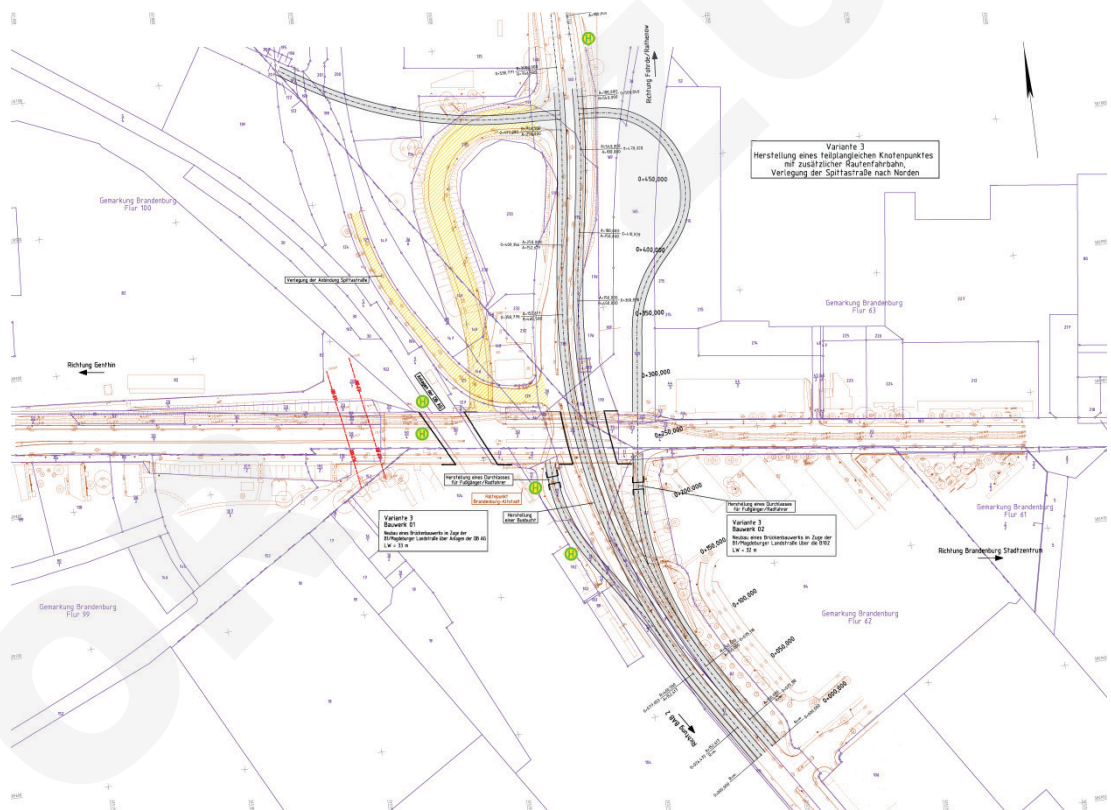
Lageplan, Knotenpunkt B1 / B102, Variante 3³
